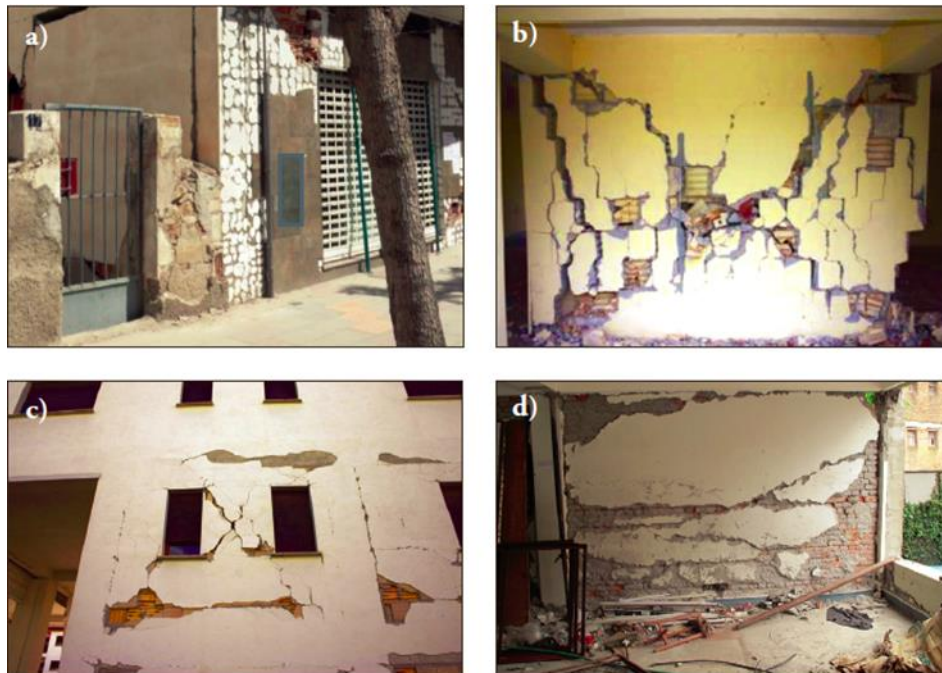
Danos em paredes de alvenaria no próprio plano: a) Destacamento do painel (2011); b) fissuração diagonal (2009); c) esmagamento de canto e fissuração diagonal (2009) e d) fissuração devido a deslizamento na zona central do painel (2015) (adaptado de Furtado 2020)
